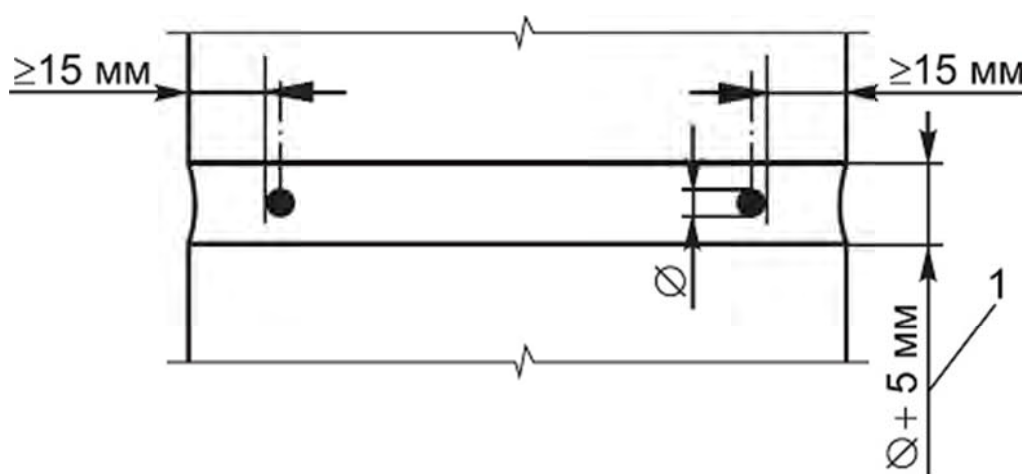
Толщина защитного слоя арматуры в горизонтальных швах:
